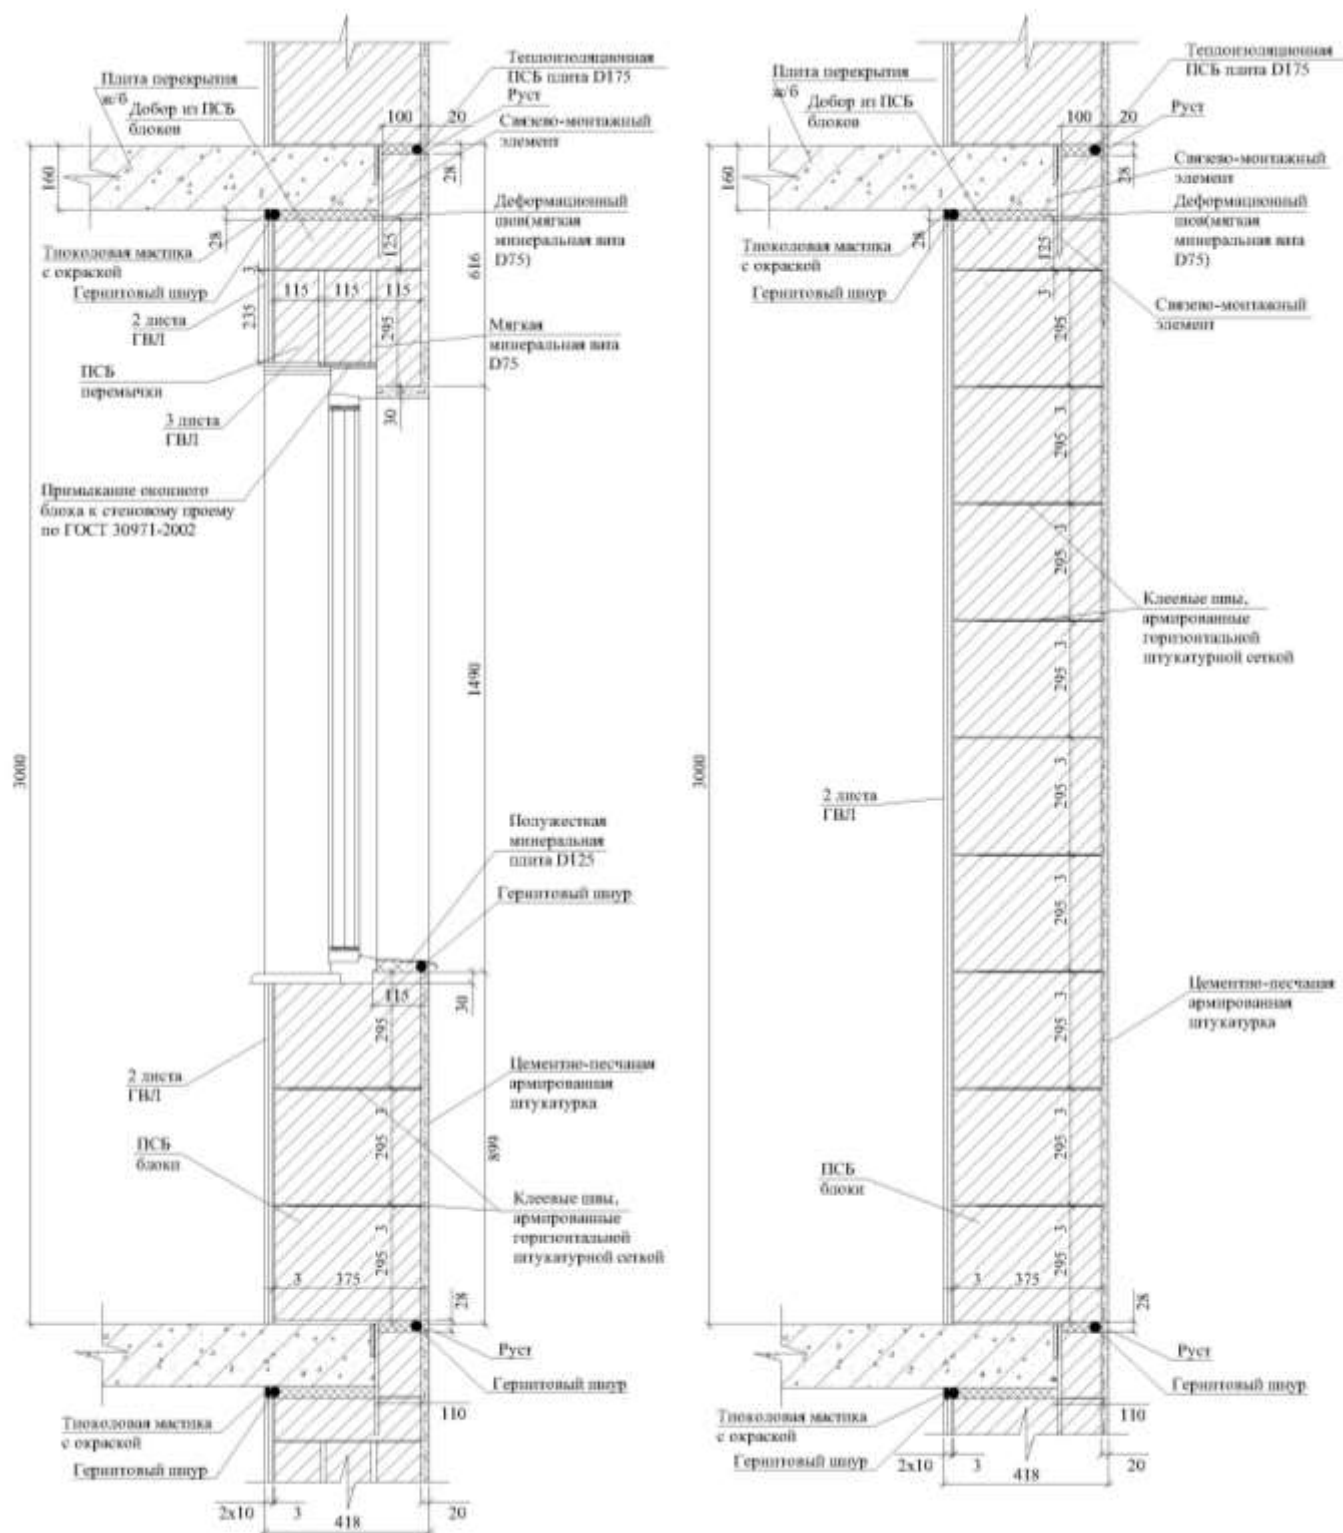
Ненесущая стена из ПСБ блоков с наружной штукатуркой и внутренней облицовкой ГВЛ. Вертикальные разрезы по оконному проему и глухому простенку
